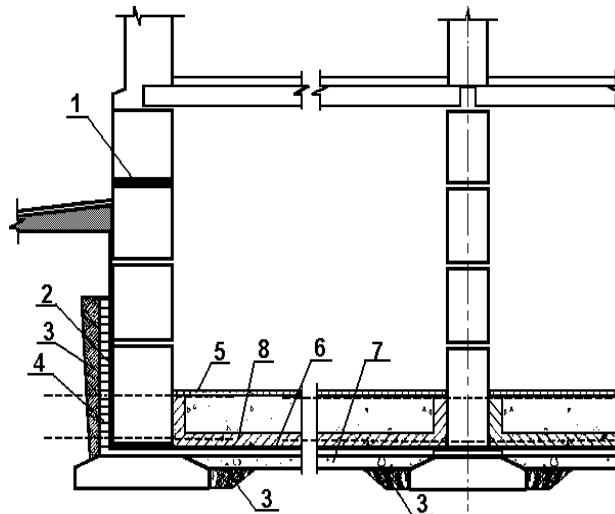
Гидроизоляция фундаментов при большом напоре.
